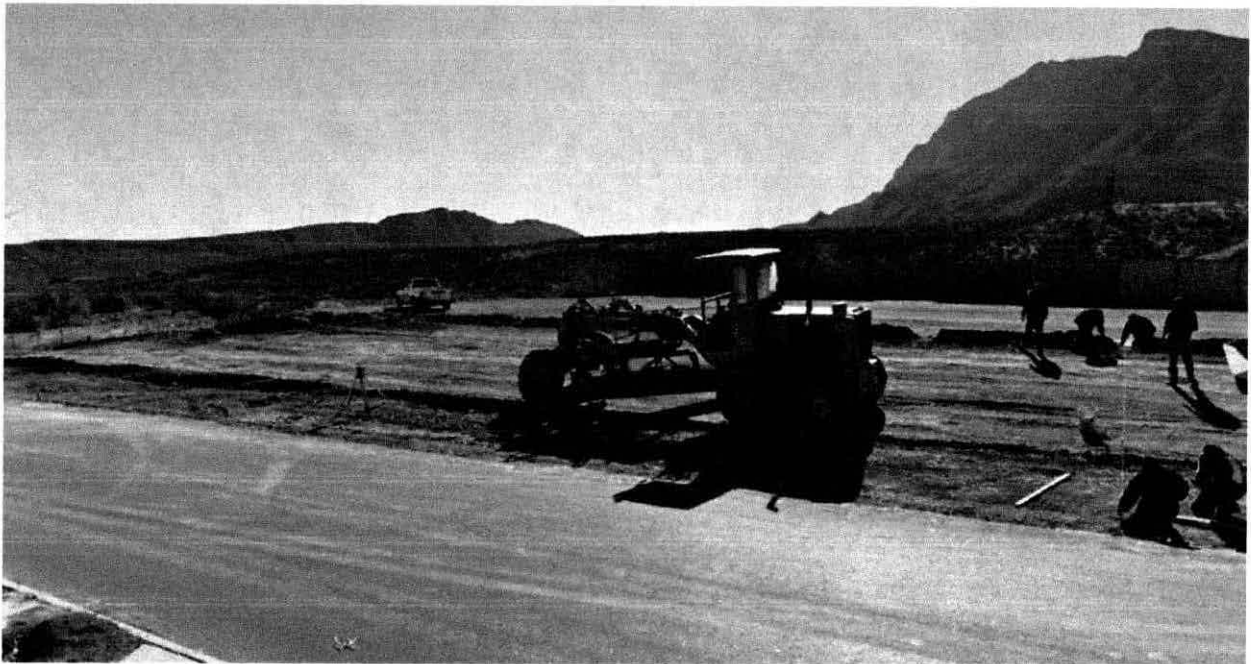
Barda Perimetral y aplanado de terreno (Noviembre 2014)
